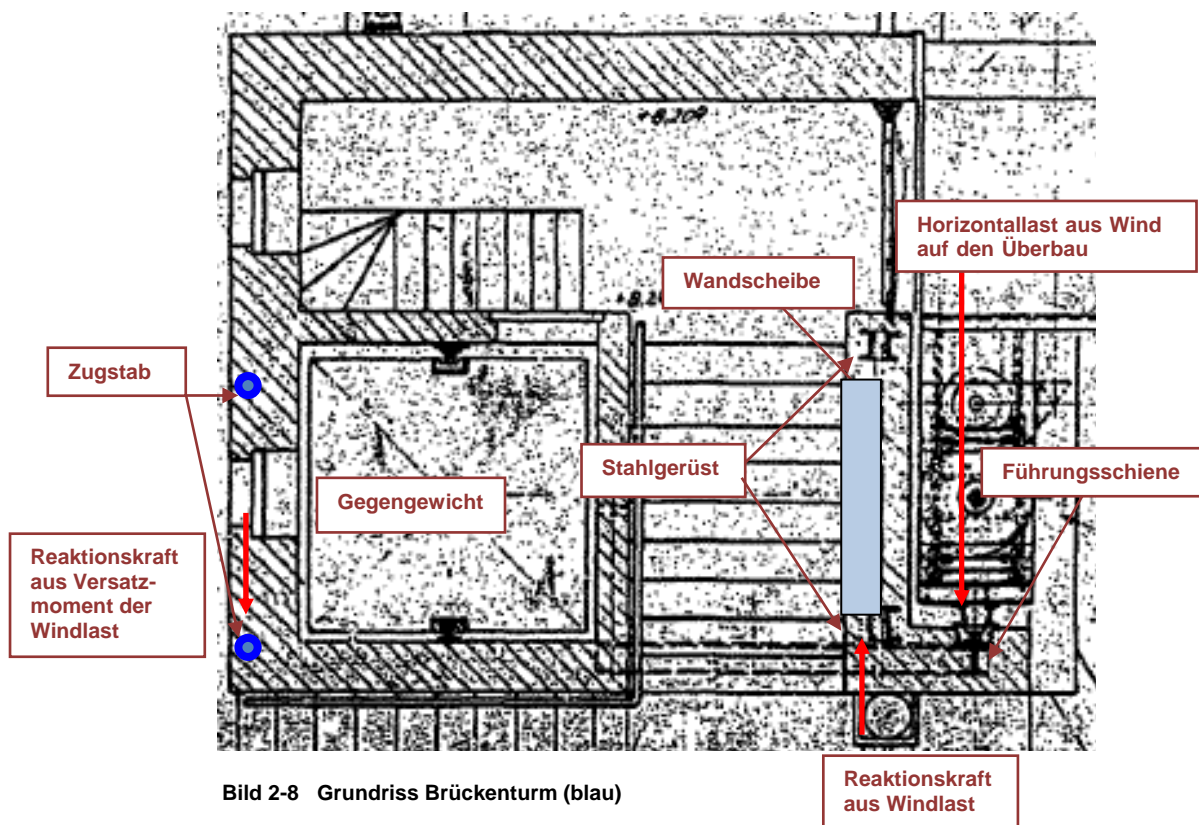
Grundriss Brückenturm (blau)
